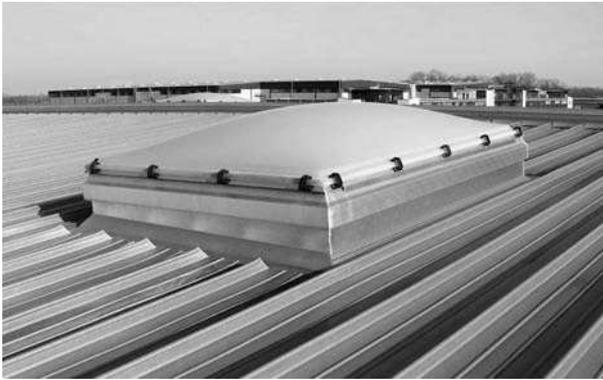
Lichtkuppel mit in die Dachfläche eingeschweißtem Abdeckkranz
